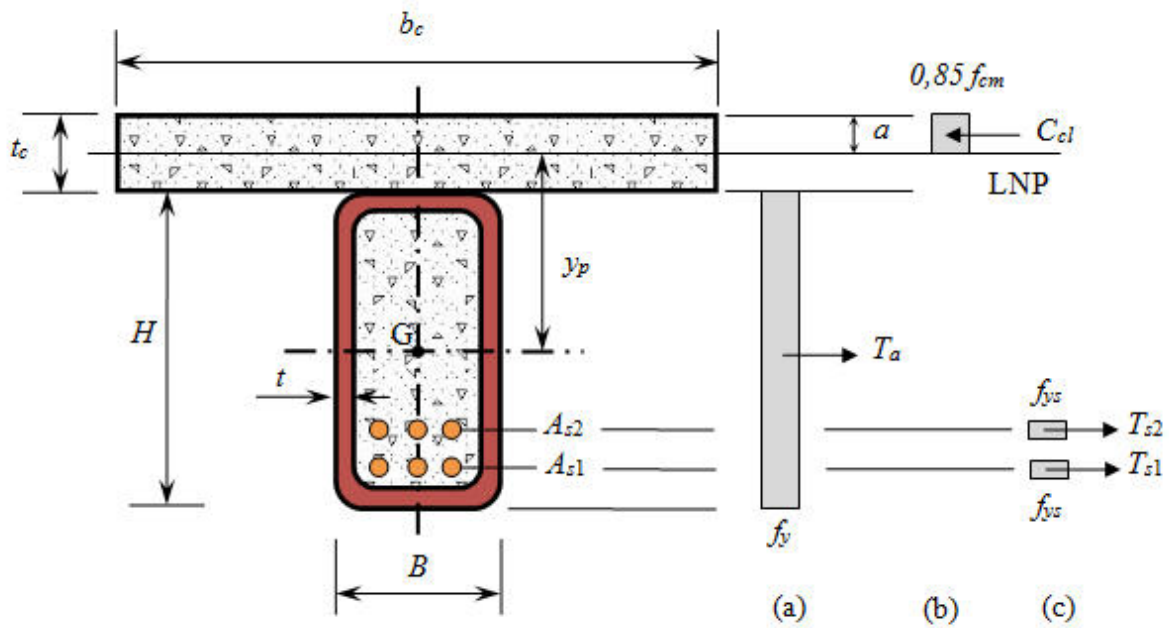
Distribuição de tensões plásticas sob momento positivo: LNP na laje
